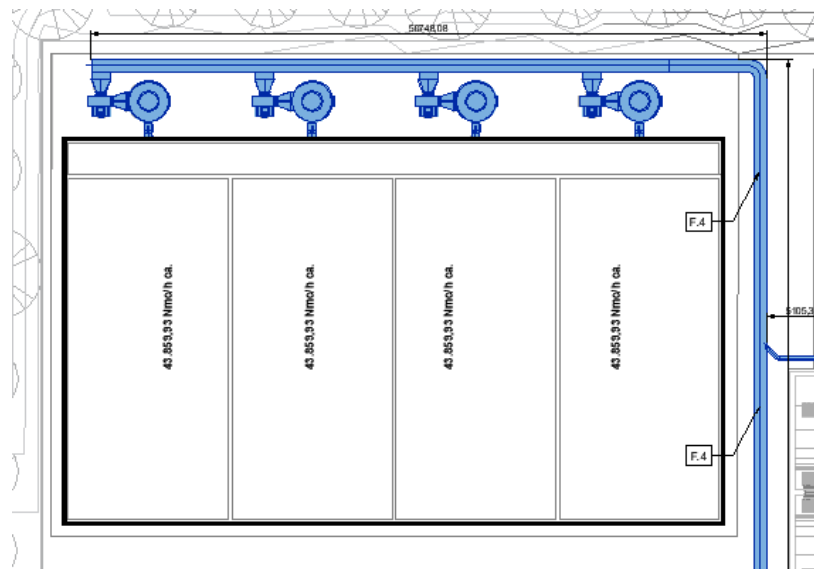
planimetria dell'area di biofiltrazione in progetto
